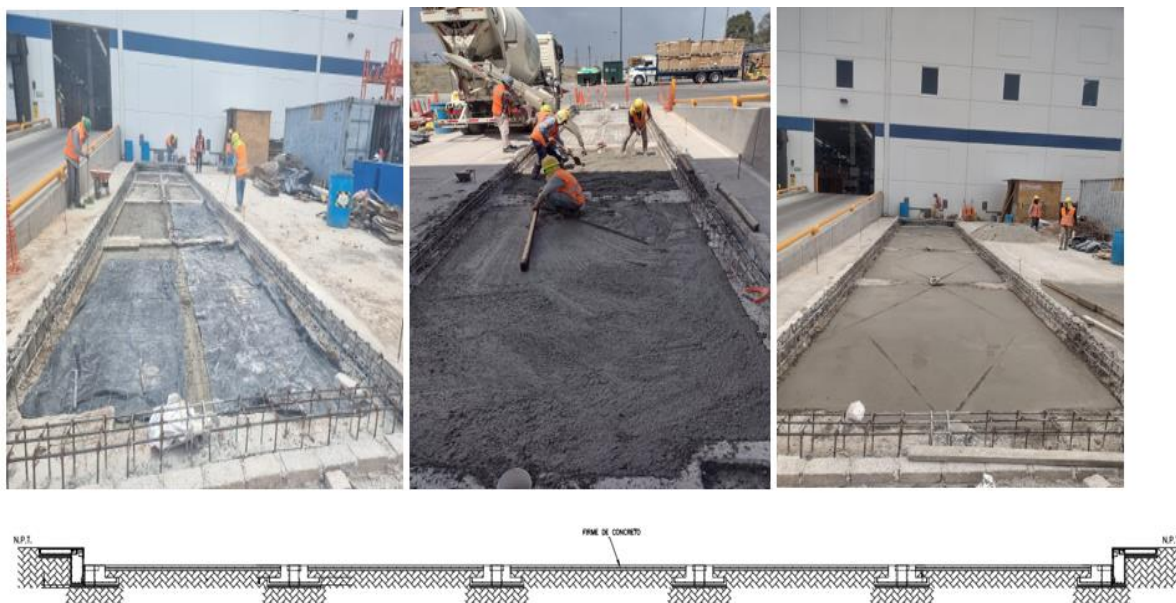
Cimbrado y colado de losa de cimentación de 15 cm de espesor
